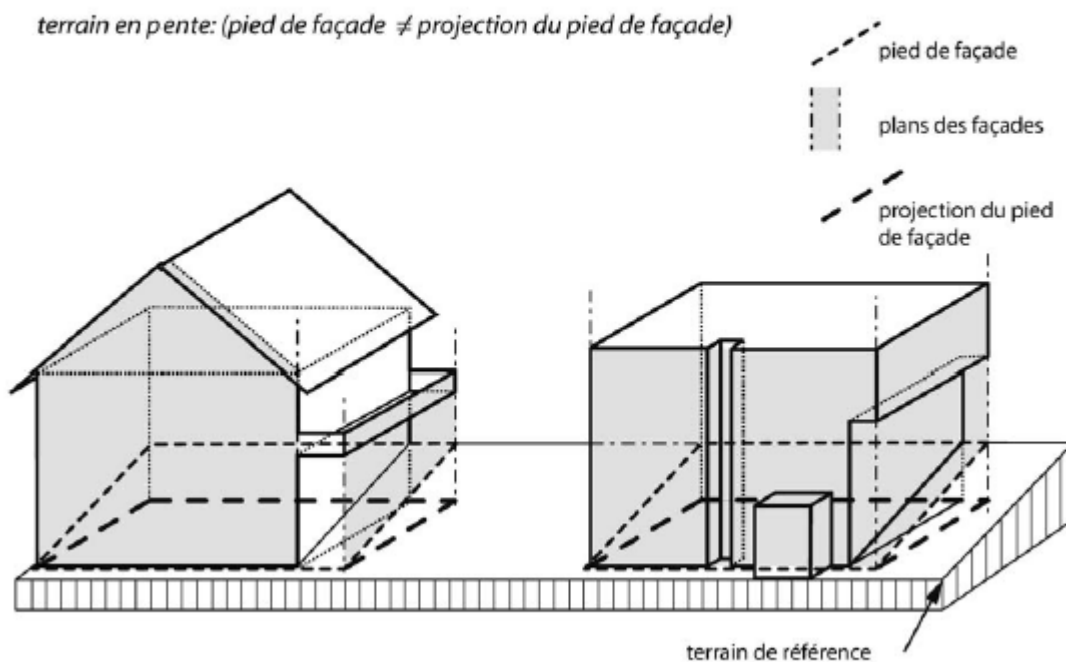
b Plans de façades et projection du pied de façade (sur terrain en pente)
